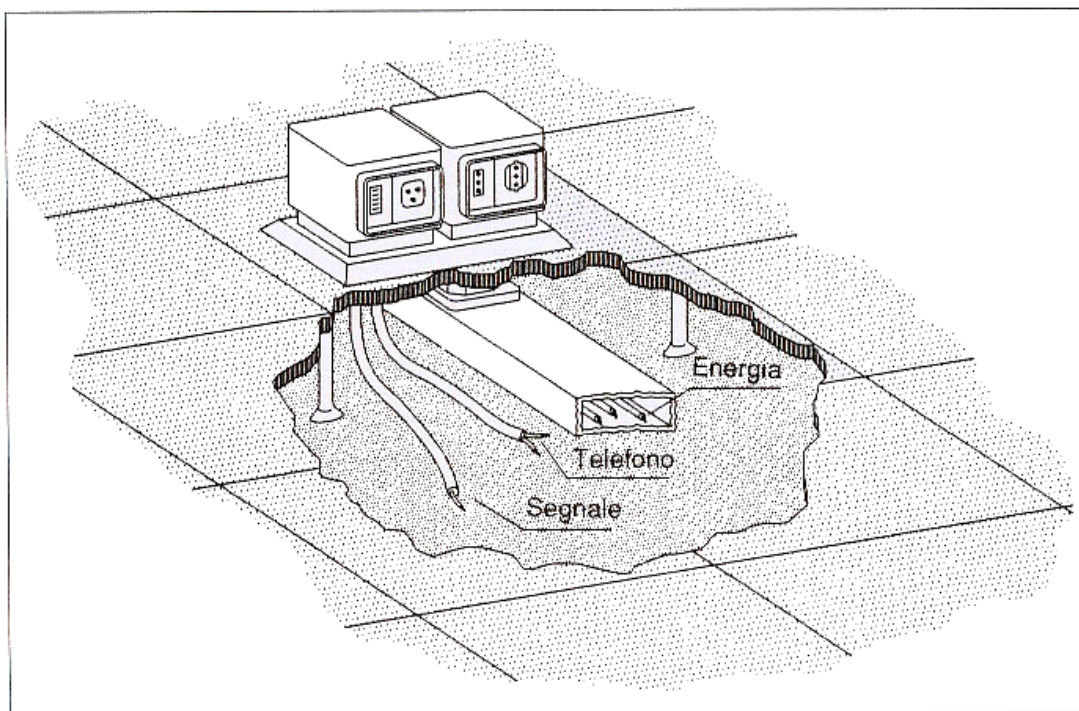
Esempio di posa sotto il pavimento galleggiante dei cavi di energia, del telefono e di segnale.
